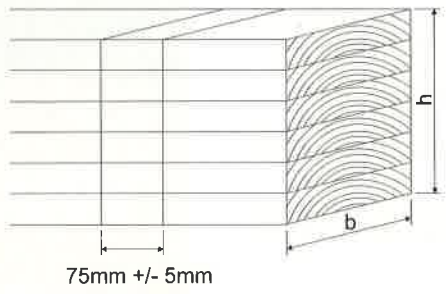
Jeder Prüfkörper soll von einem vollständigen Querschnitt des zu prüfenden Bauteils stammen
